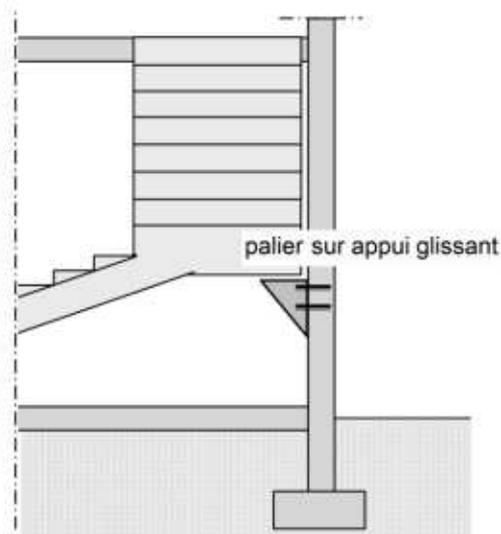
exemple de l'utilisation d'un appui glissant
